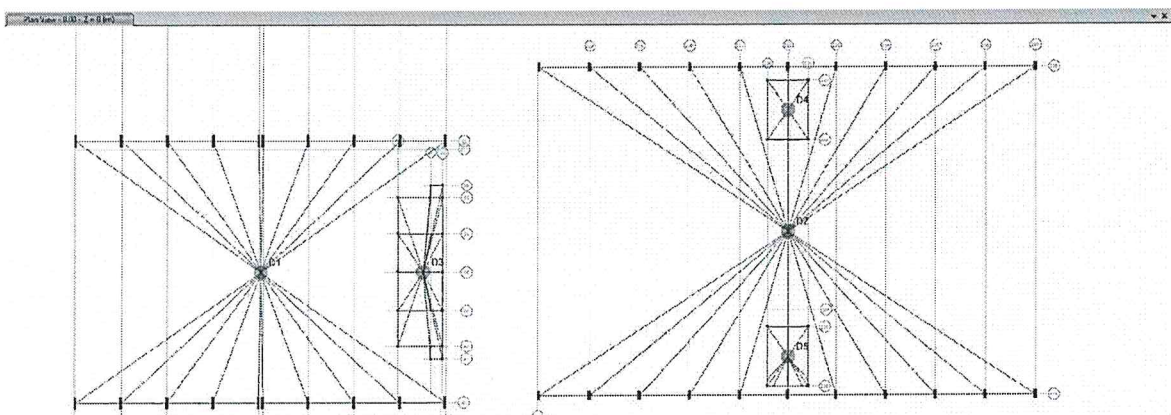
Vista en planta de los Diafragmas del modelo estructural de la Edificación 19-20 sistémico analizado.
